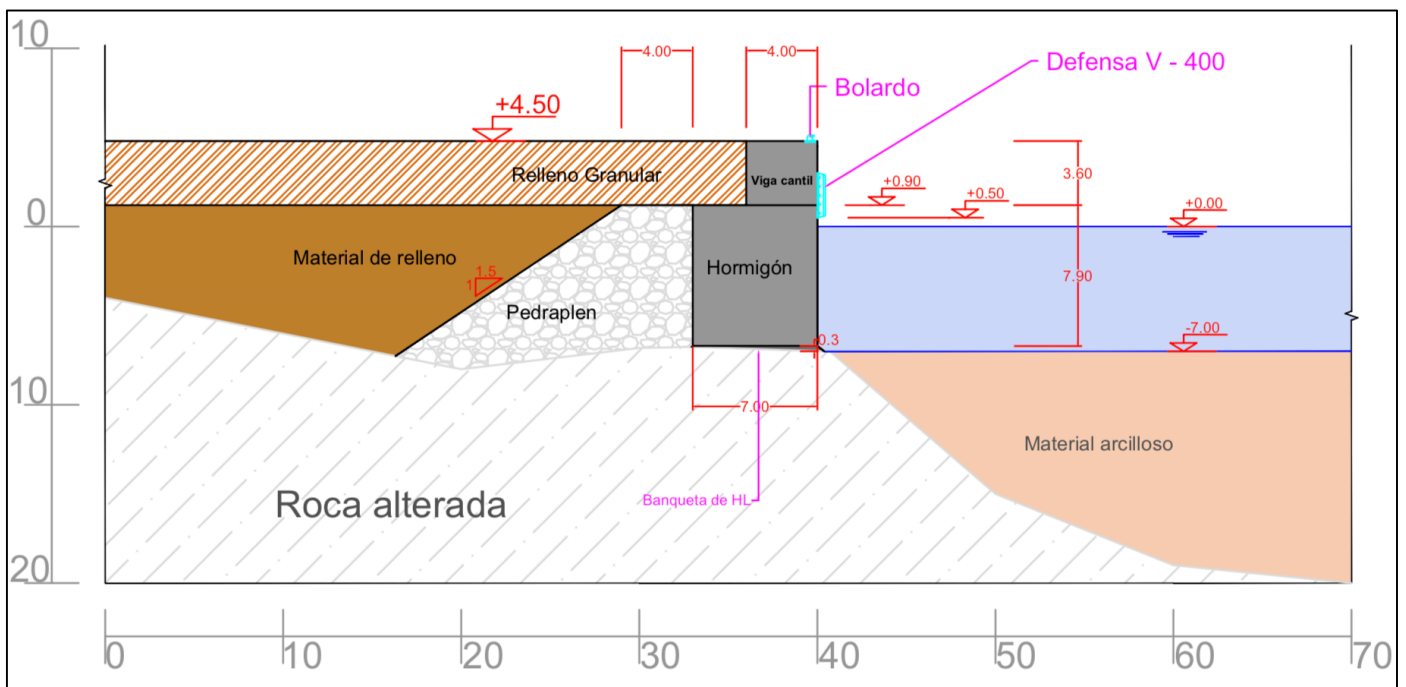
Croquis de la alternativa 1 (En ningún caso se puede usar como plano constructivo)
